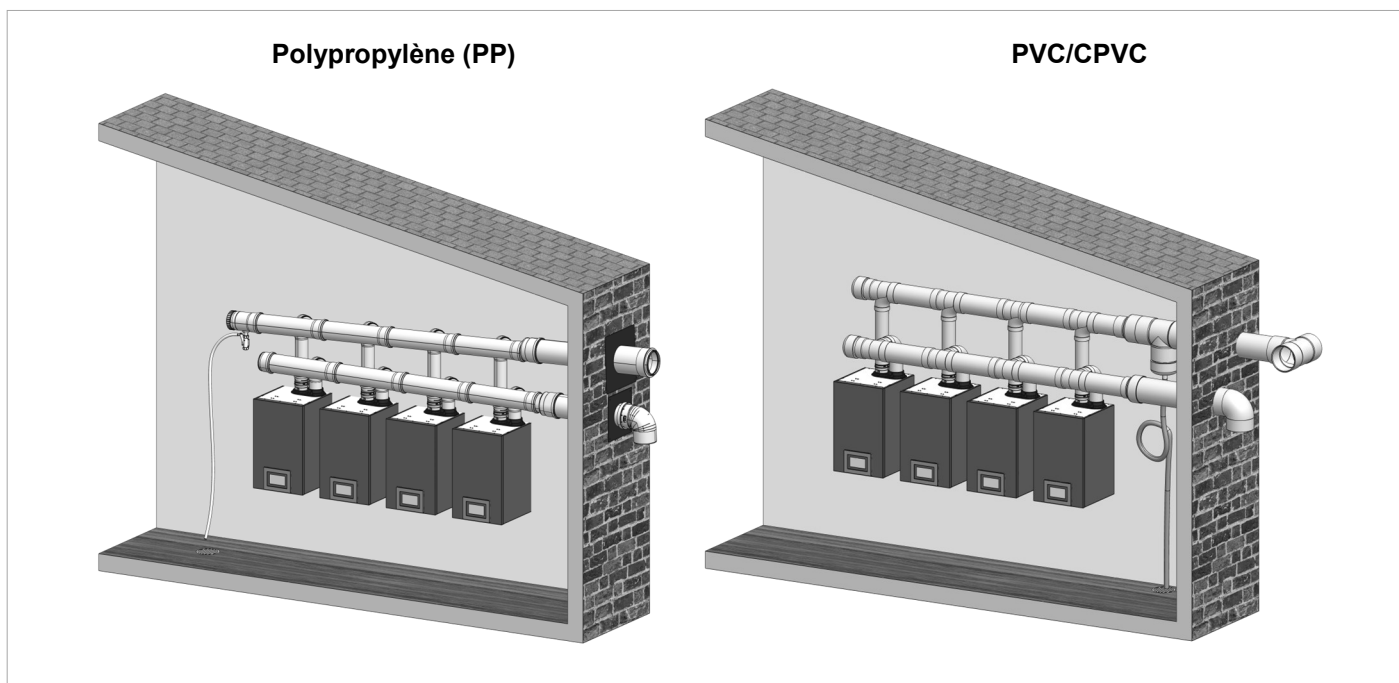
Exemple de terminaison horizontale (conduits jumelés)
